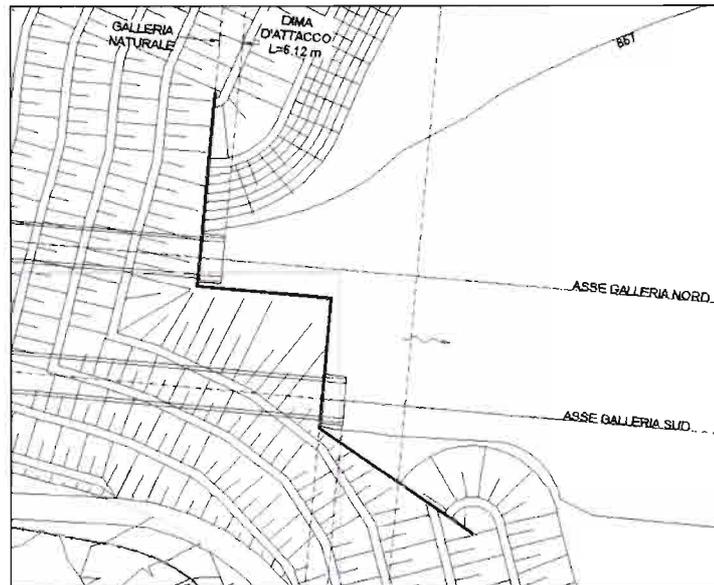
Stralcio Planimetrico delle opere di sostegno
